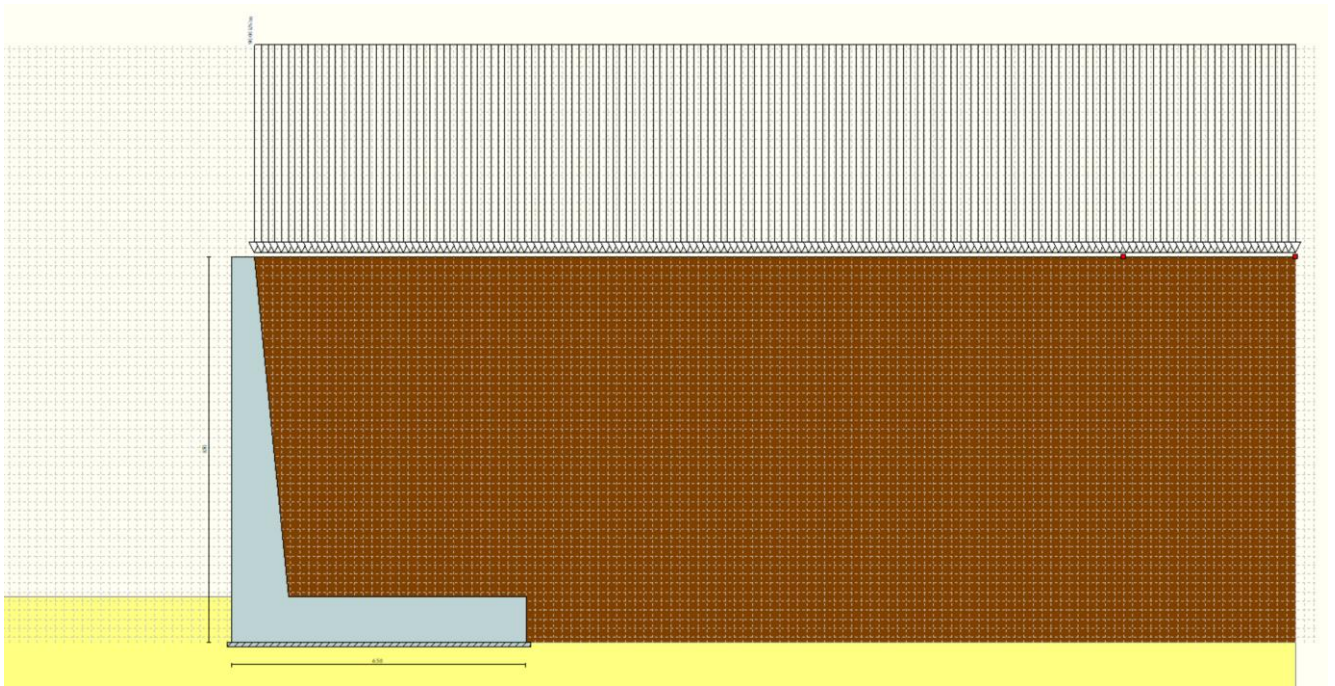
Modello di calcolo Sezione tipologica 1 - Muro a L, carico permanente di rilevato
